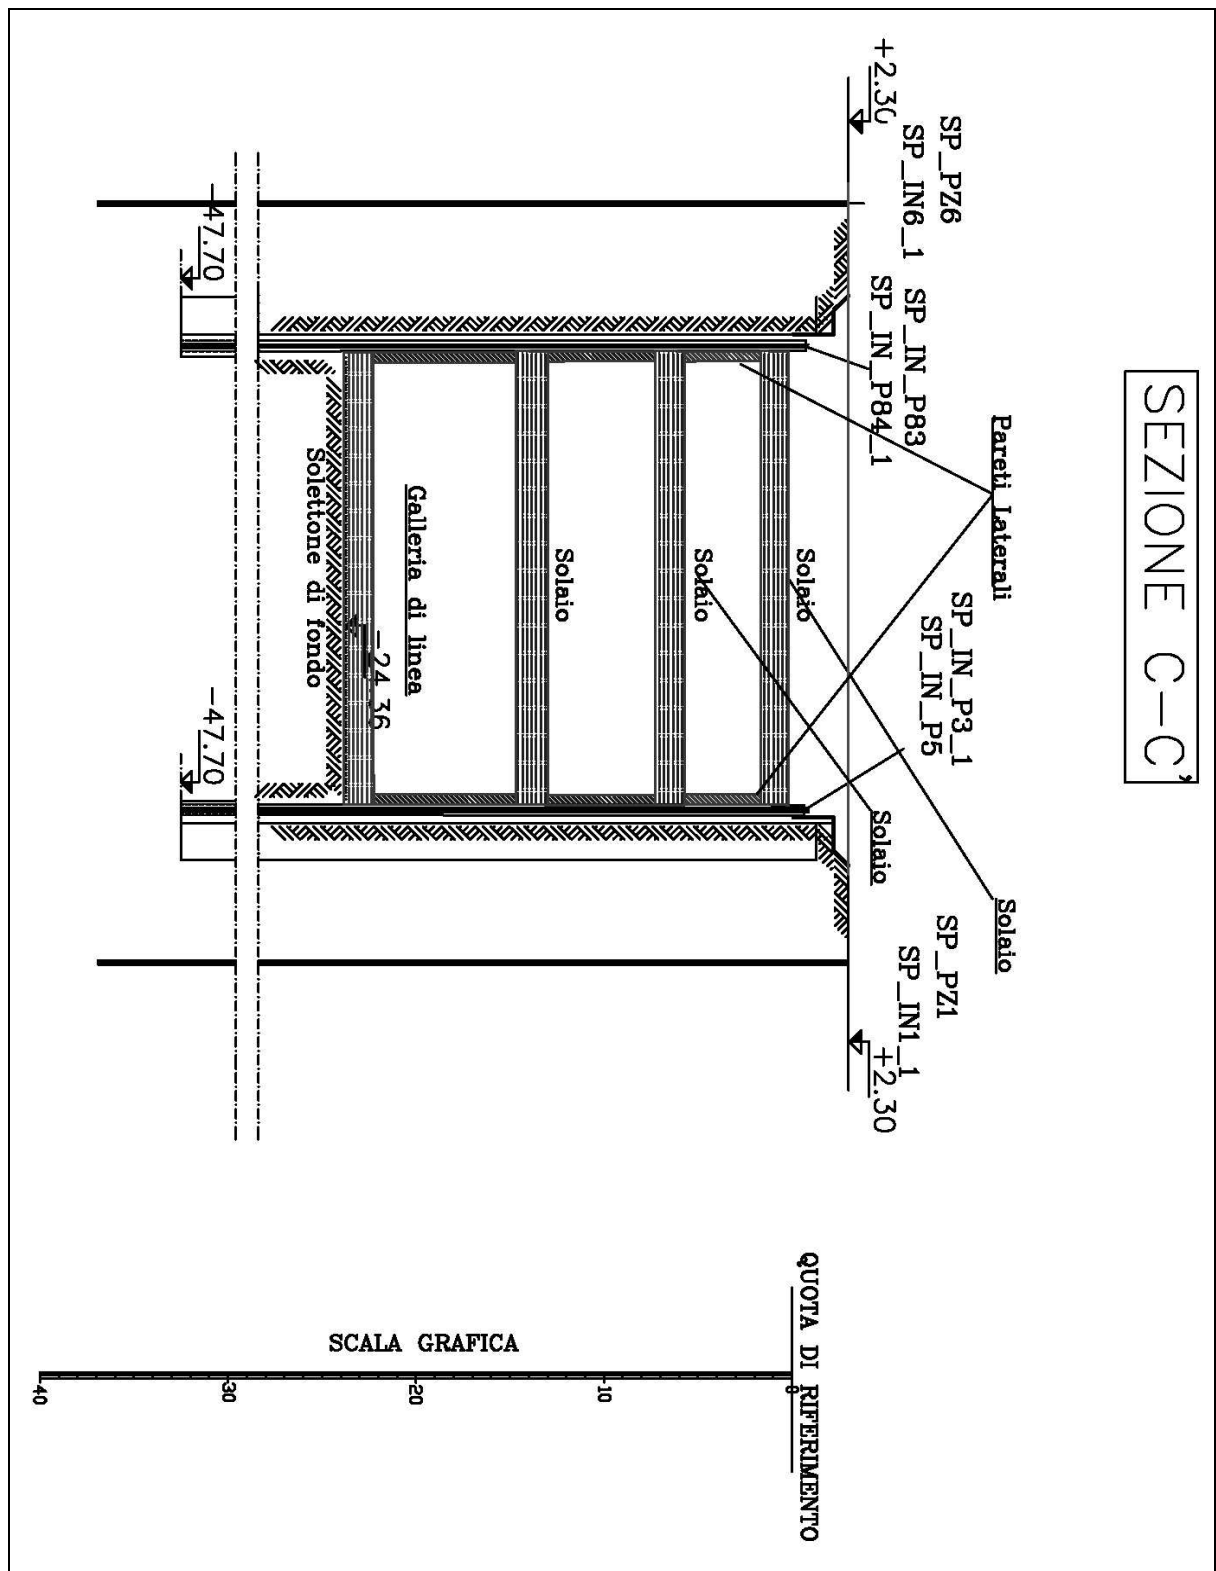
Sezione C-C' pozzo stazione, raffigurante la suddivisione in aree di lavoro.
